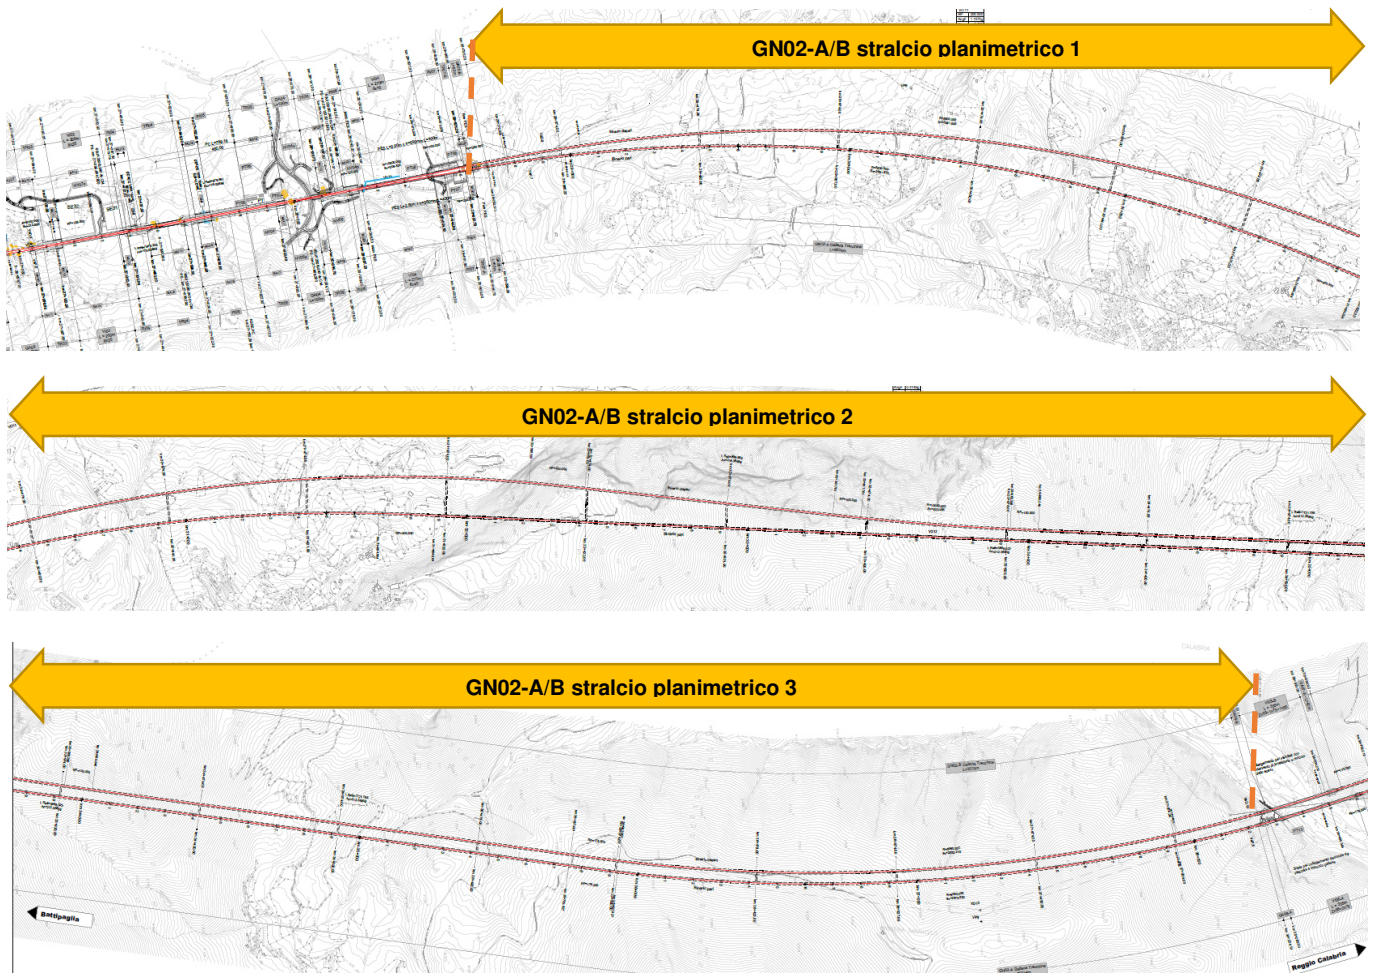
Planimetrie di progetto gallerie GN02-A/B da km 28+646 al km 38+260 BP
